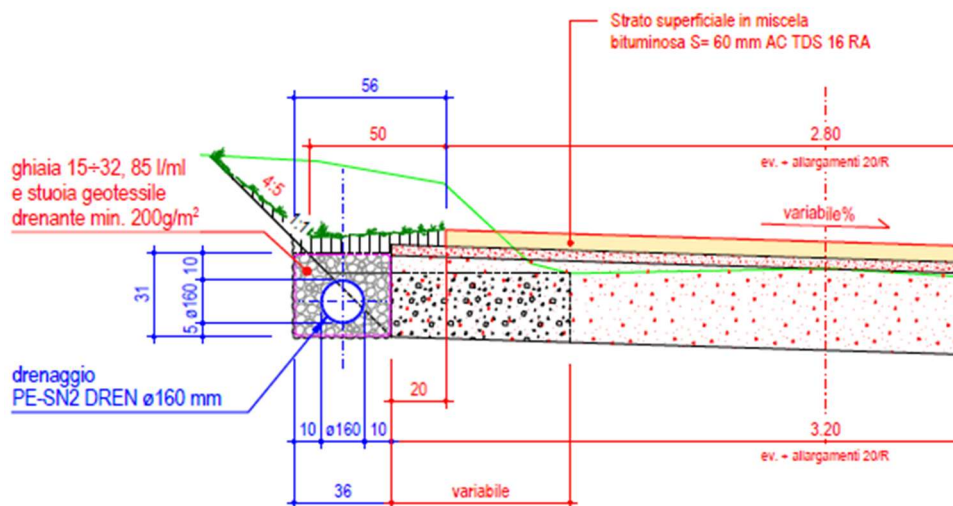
Dettaglio tipo drenaggio con stabilizzazione
